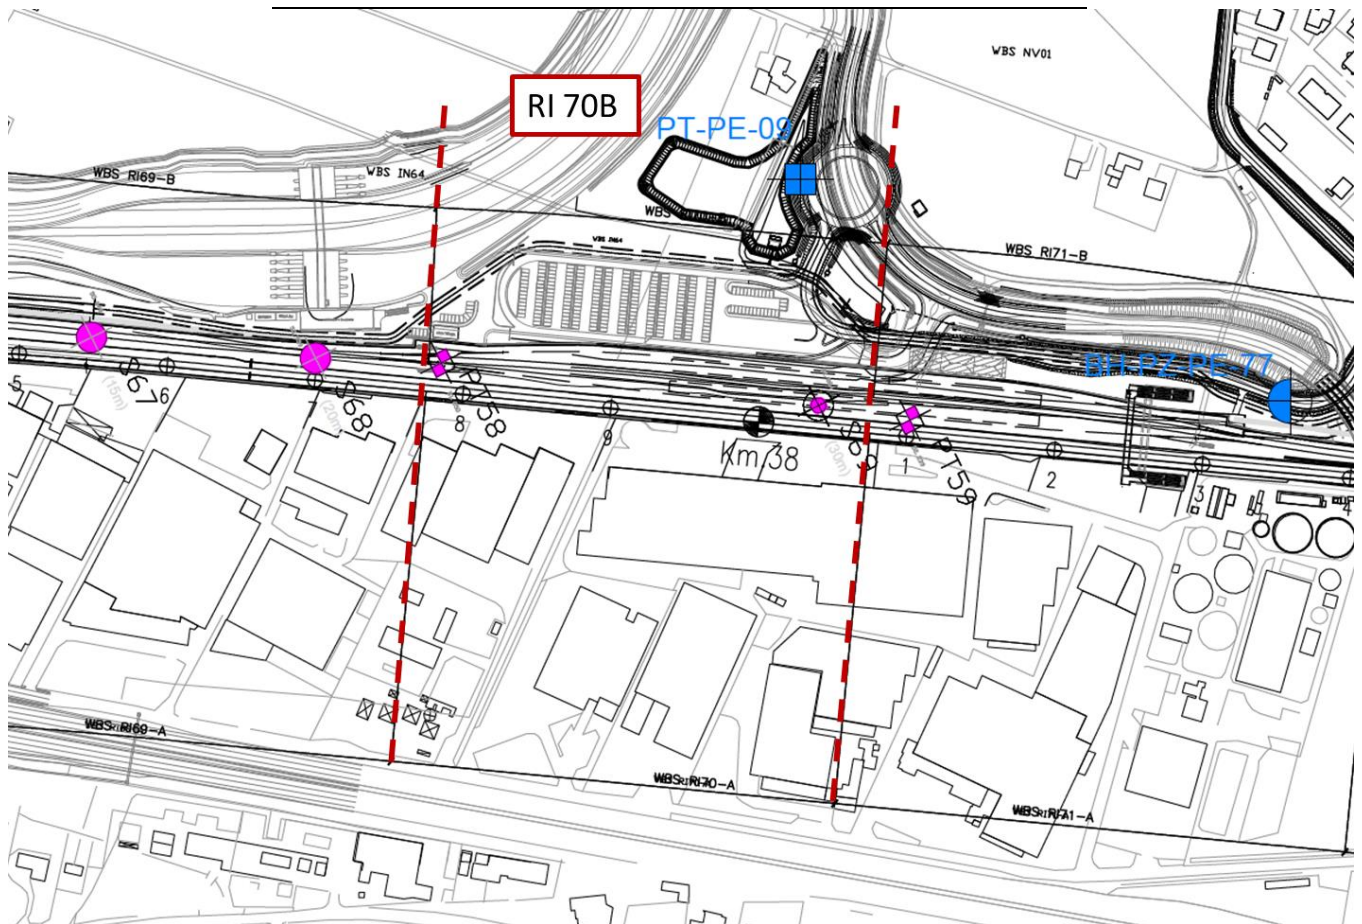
Planimetria Rilevato RI70B, estratto dalla Planimetria Generale (Doc. Rif. [3])
